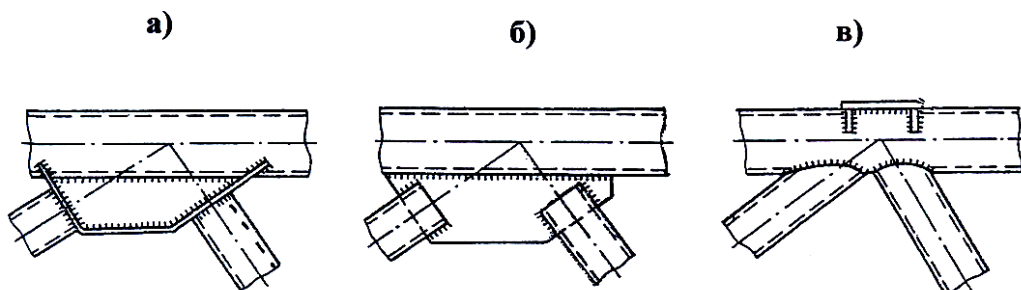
Узловые соединения раскосов с верхним трубобетонным поясом ферм: а),б) с помощью фасонки, в) непосредственное [3]
